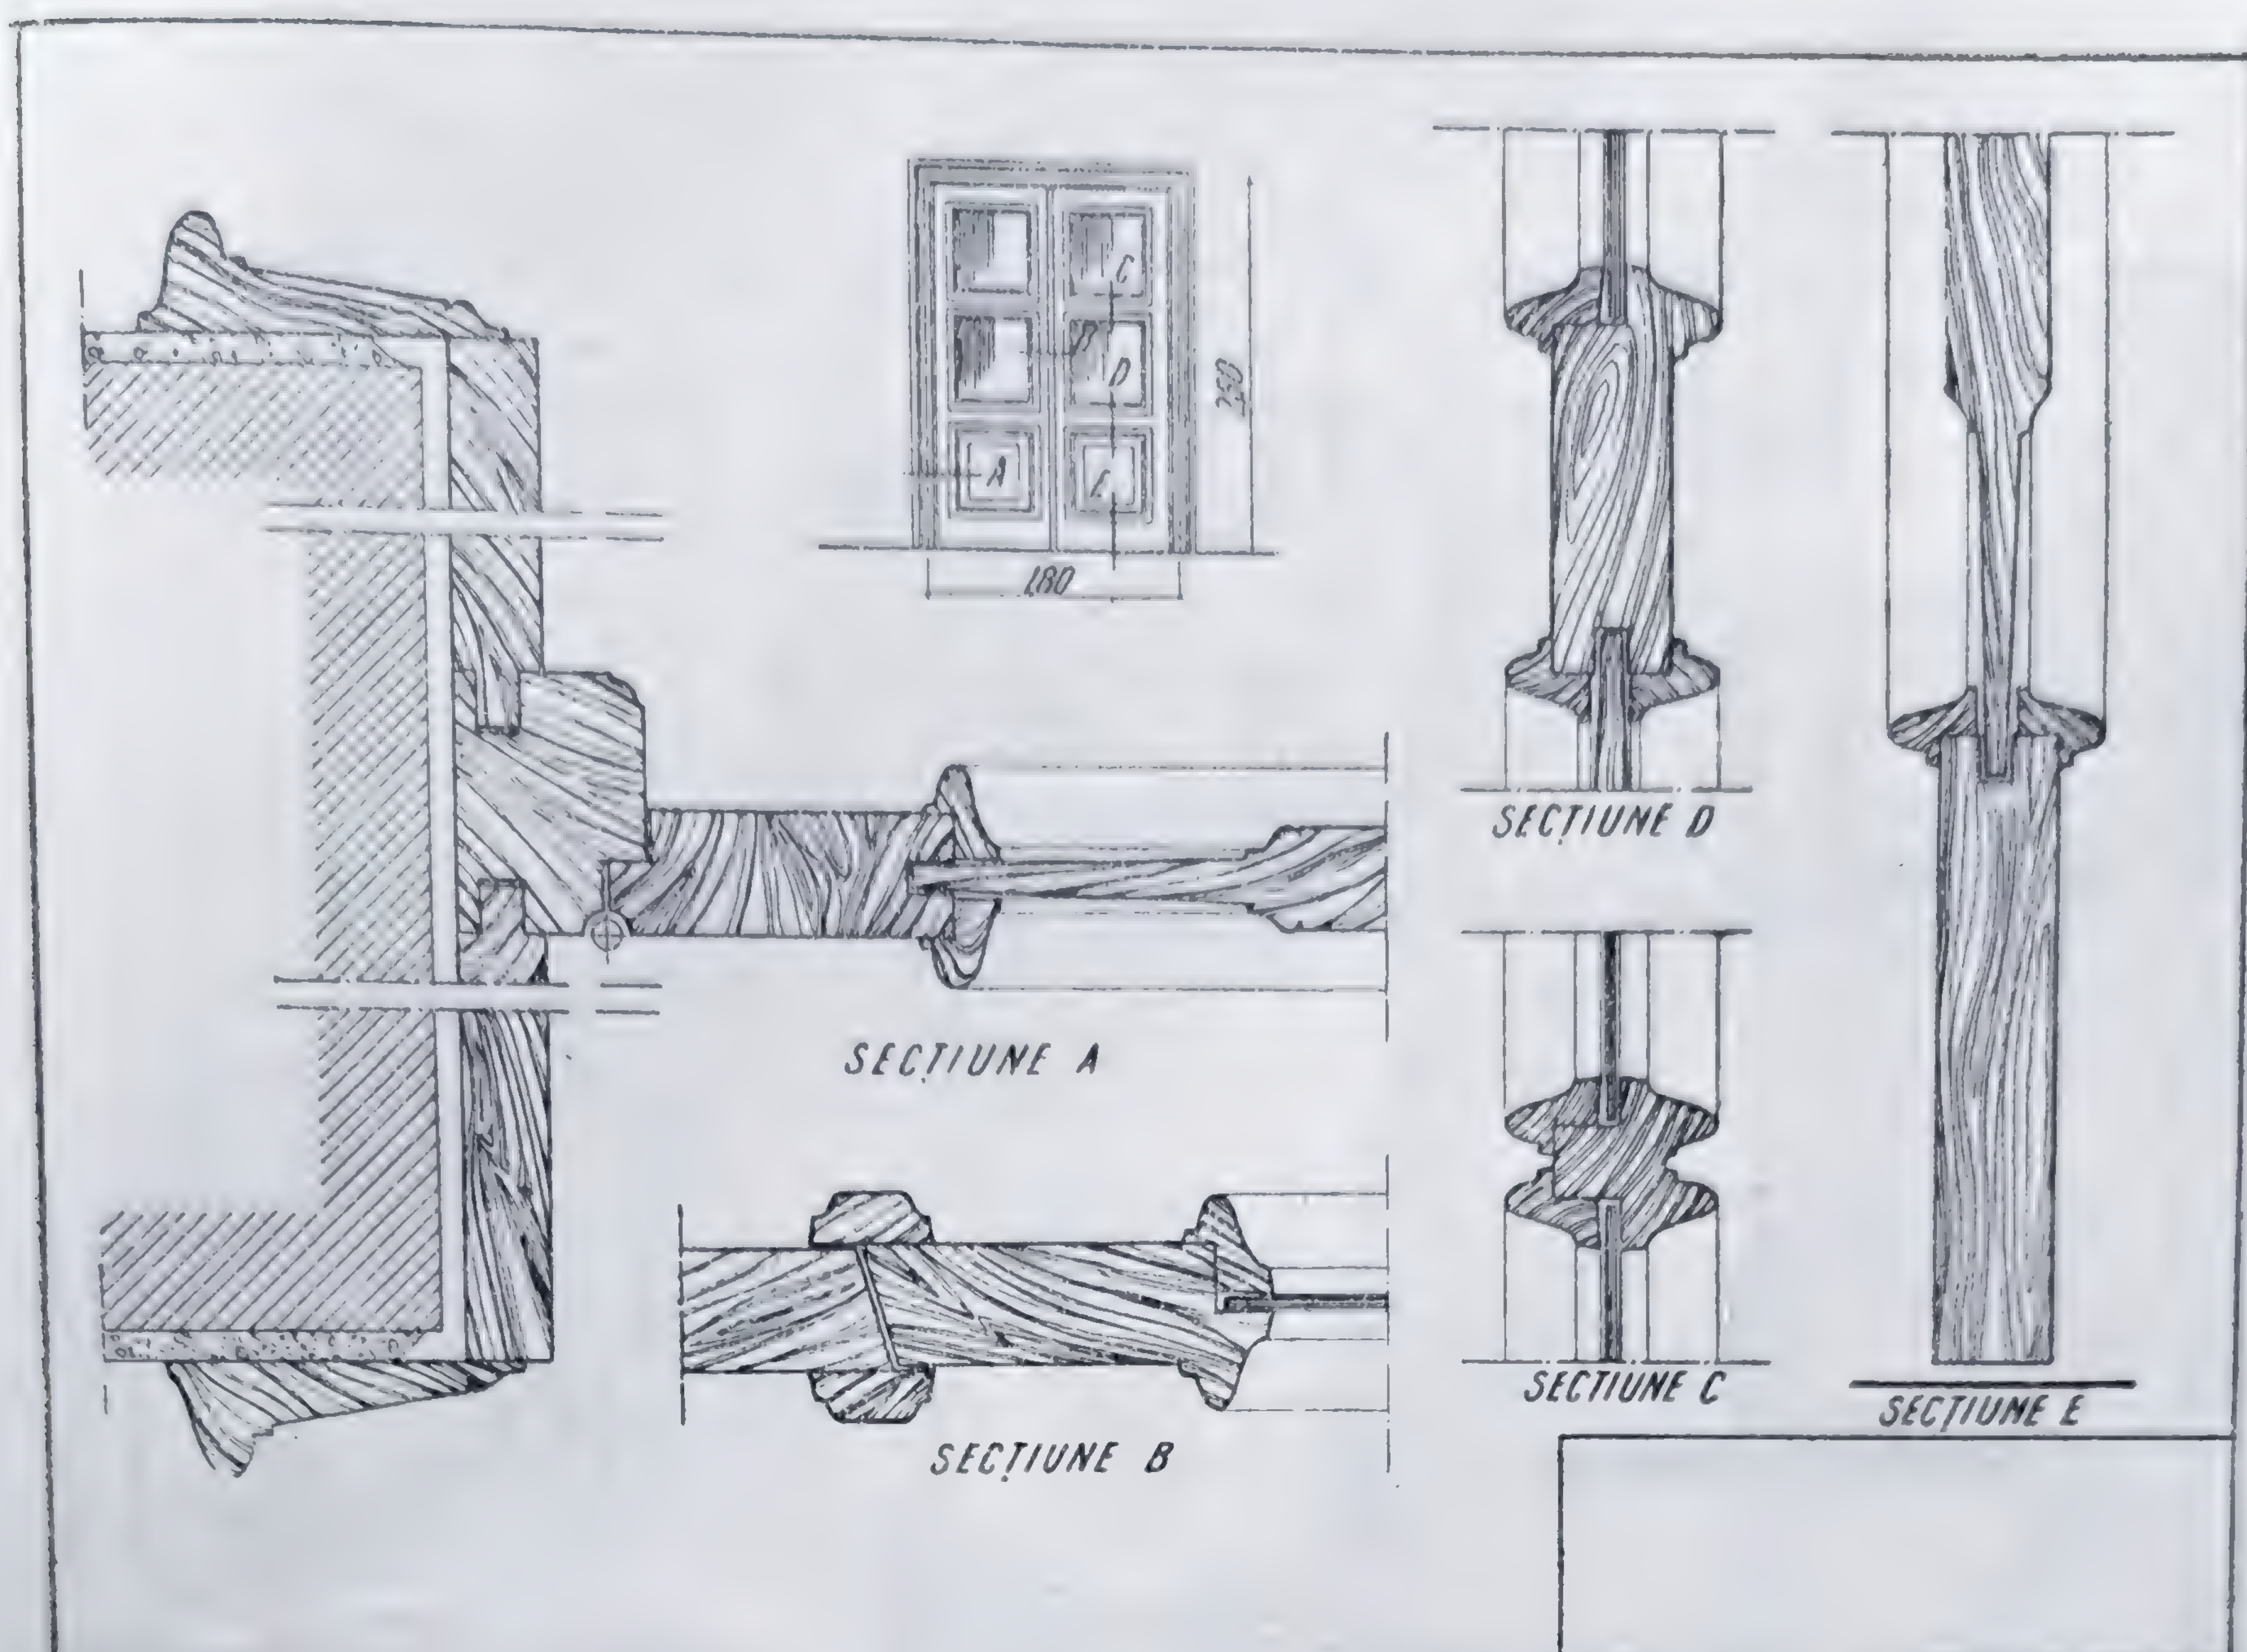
Desen pentru detaliu de uşă din lemn în rame şi tăblii cu geam.
